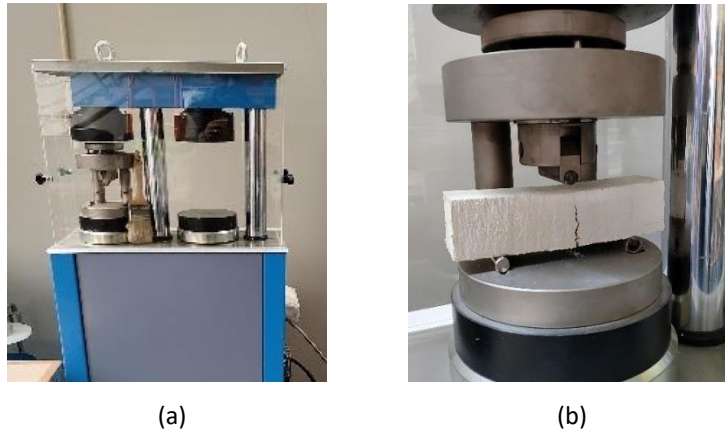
Determinação da tensão de flexão: (a) máquina de ensaio de à tração por flexão; (b) rotura do provete à tração por flexão [Fonte – Autor]
